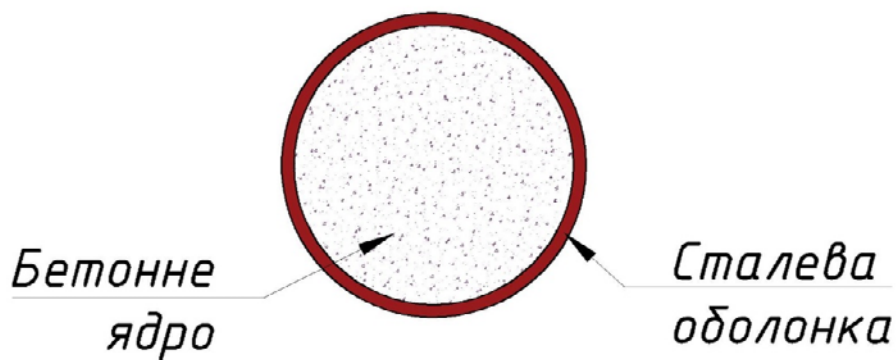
Переріз звичайного трубобетонного елемента
